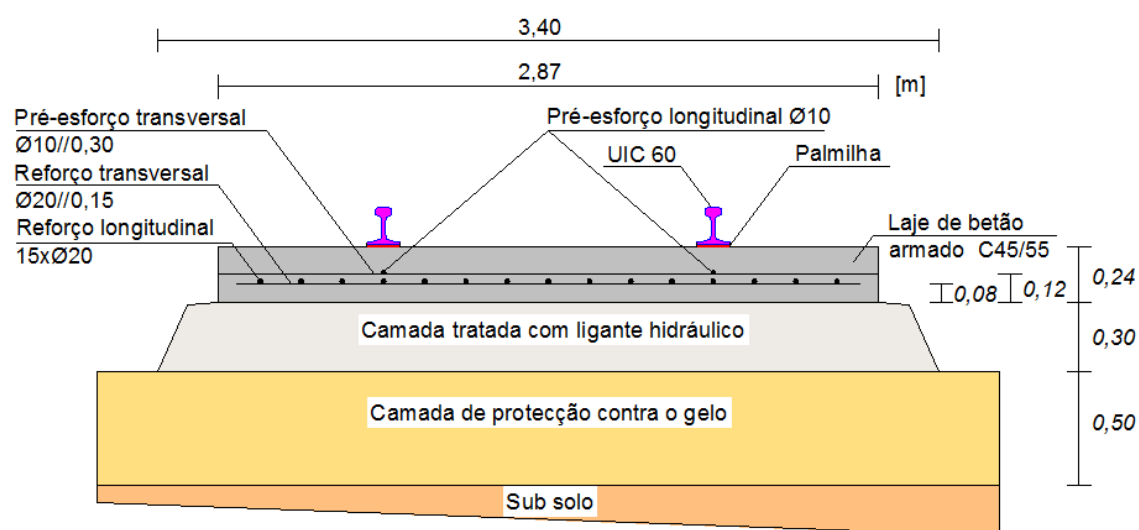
Perfil transversal esquemático da via em laje com armadura ordinária inferior e pré-esforço transversal e longitudinal (Marques, J. 2013)
